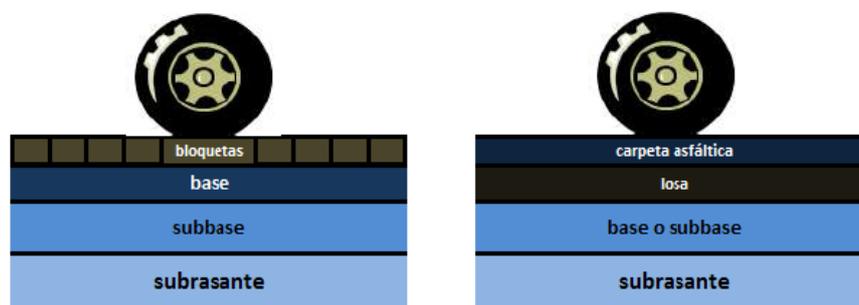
Esquema de paquete estructural para pavimento híbrido
